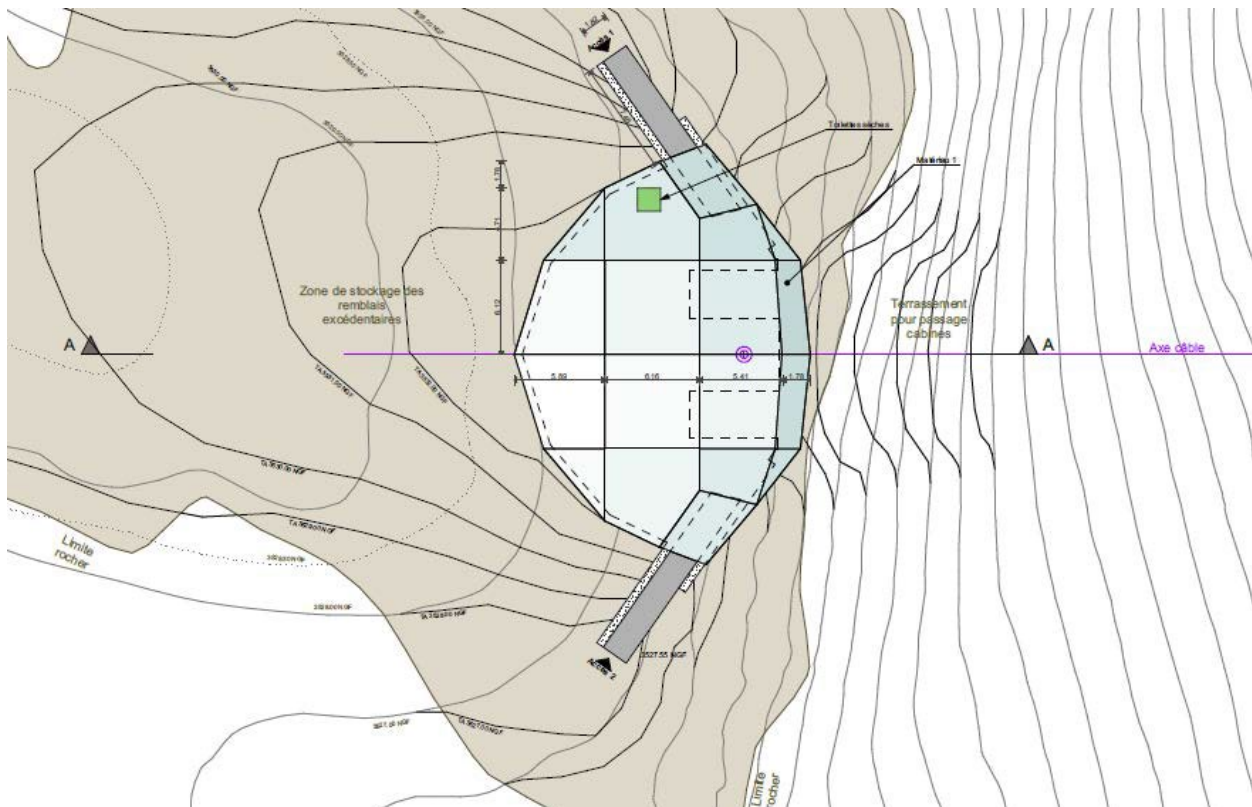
Plan de la gare 3600 - en beige les zones de dépôt de déblais - la gare 3200 est à 1 800 m en partant vers la droite (source : dossier).
